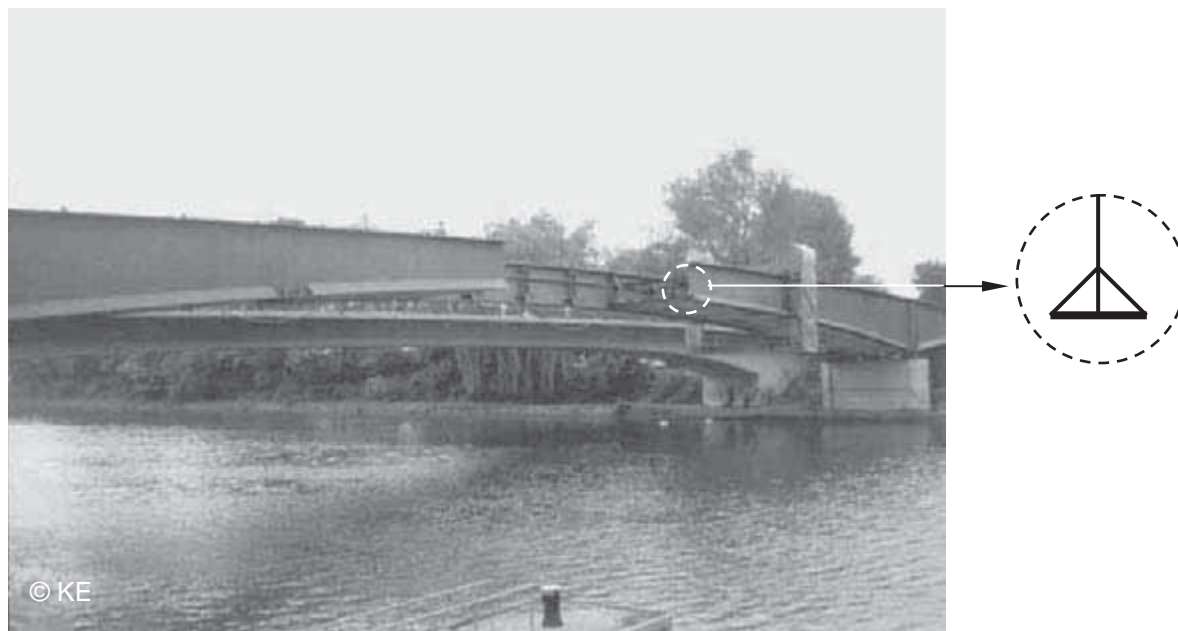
Pont à poutres en I comportant des plaques de semelle inclinées.
